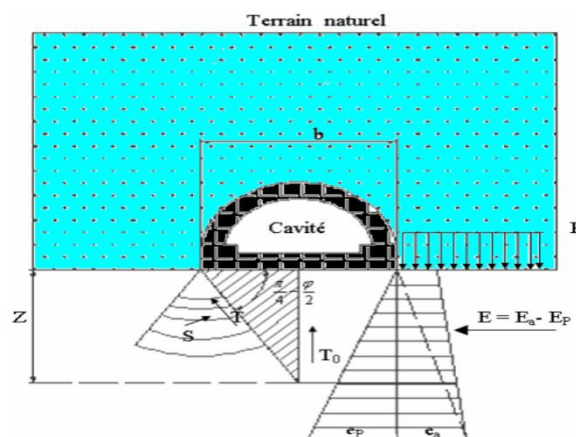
La poussée au niveau de radier selon TSIMBARIÉVITCH
